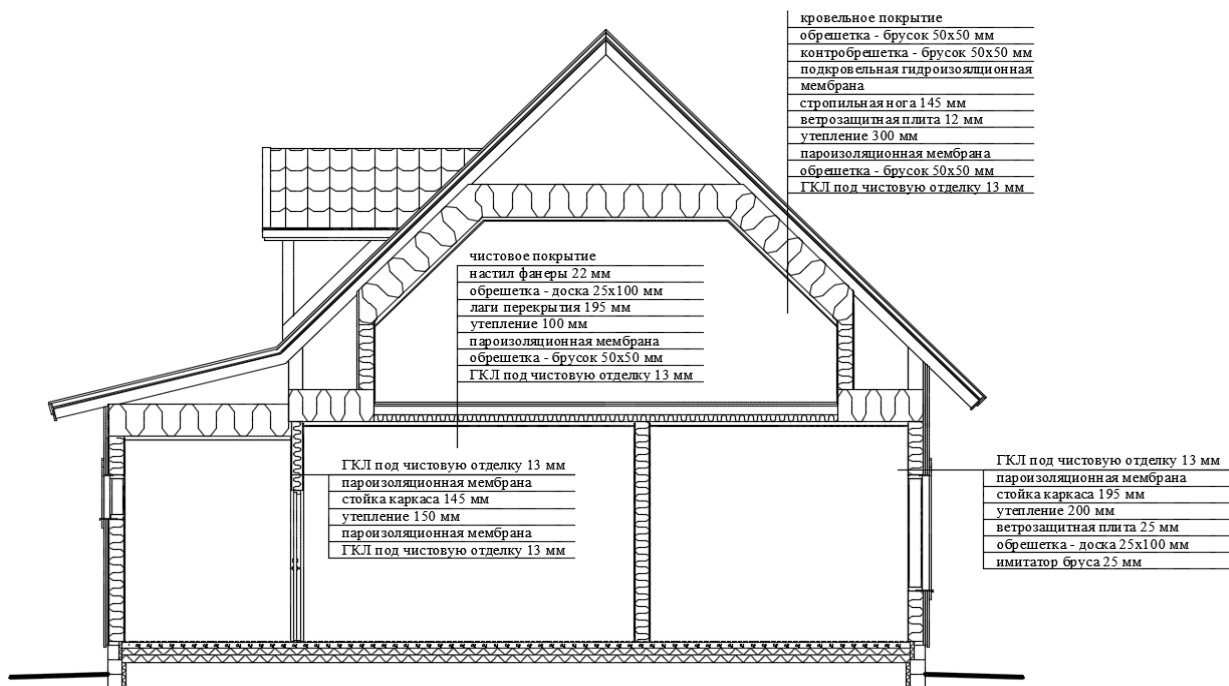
Конструкция стен, кровли, перегородки, перекрытия каркасного дома
